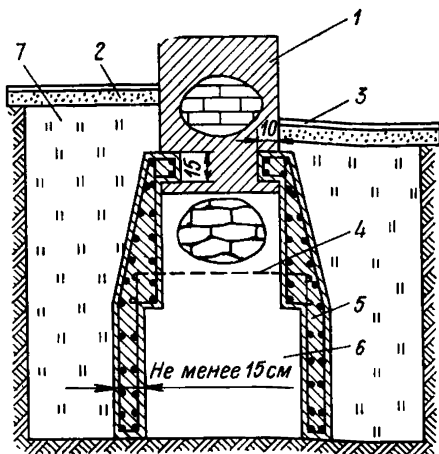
Усиление наружных фундаментов железобетонными обоймами
